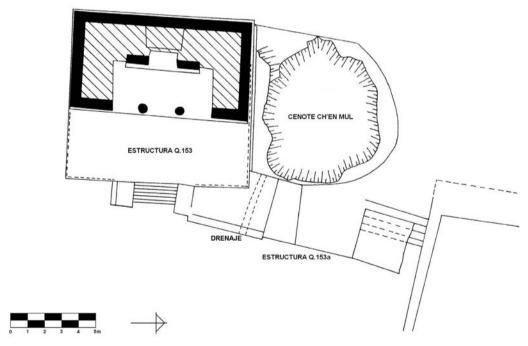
Planta de la Estructura Q.153 y del Cenote Ch'en Mul . Se observa las tres etapas constructivas de la Estructura Q.153a, que cierra el brocal del cenote en el costado oriente.
